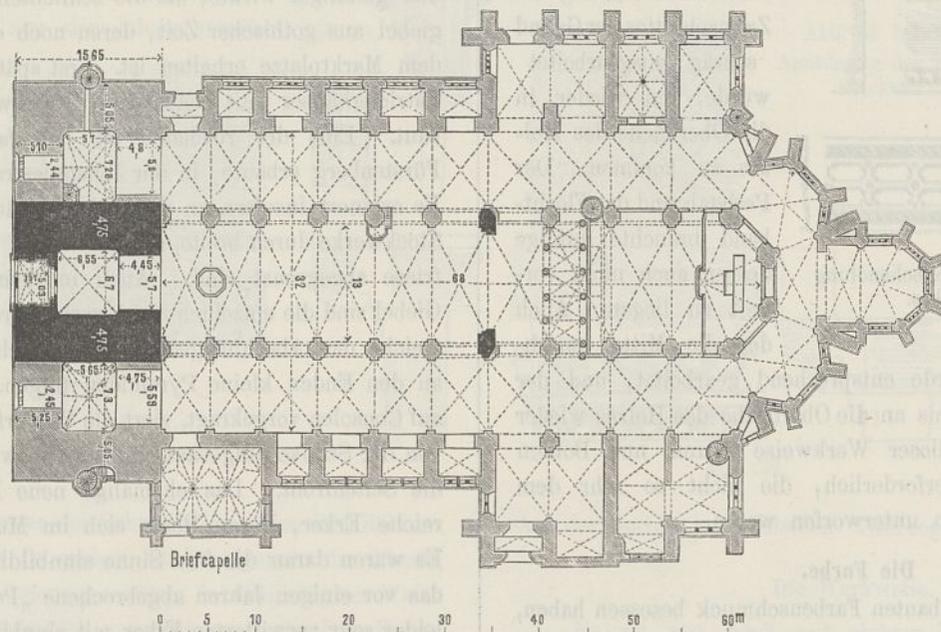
St. Marienkirche in Lübeck, Grundriß.
